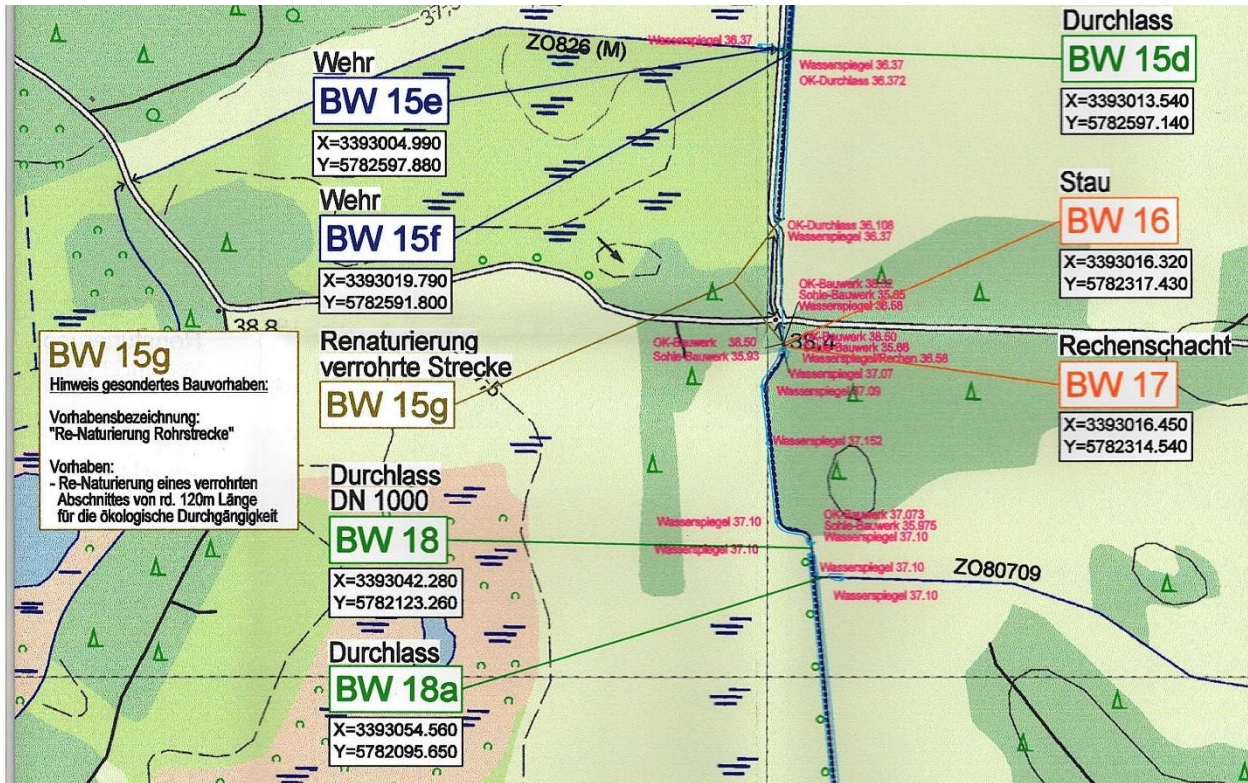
Auszug Lageplan Rohrleitung, Rechenschacht, Stau im Johnegraben (Entwurfsplanung 2010)
